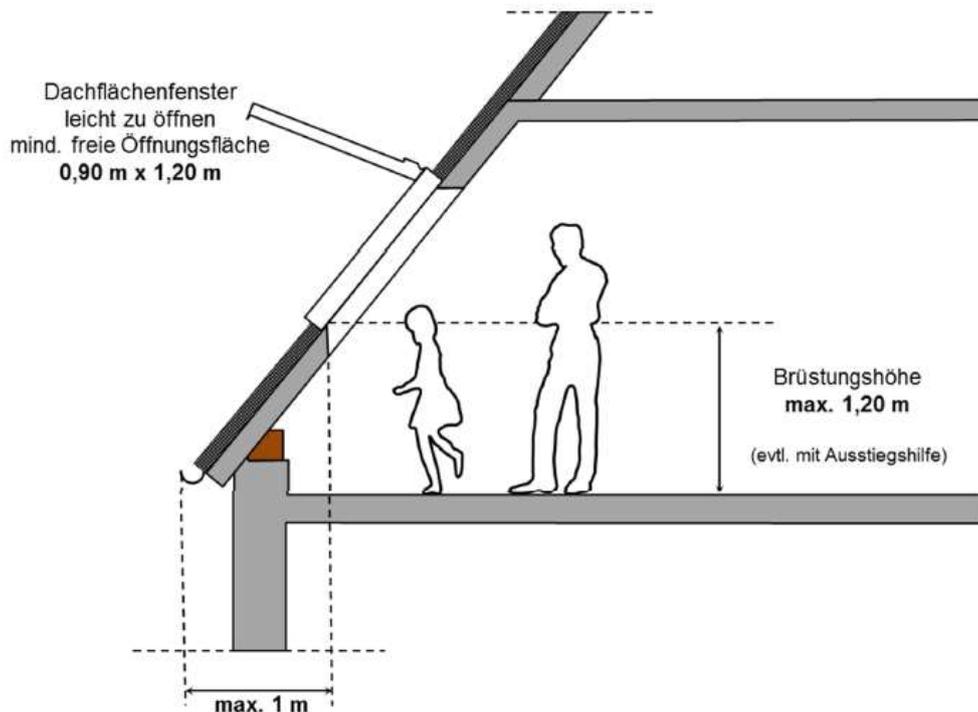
Rettungsweg aus Dachgeschoss über Dachflächenfenster<sup>1</sup>
